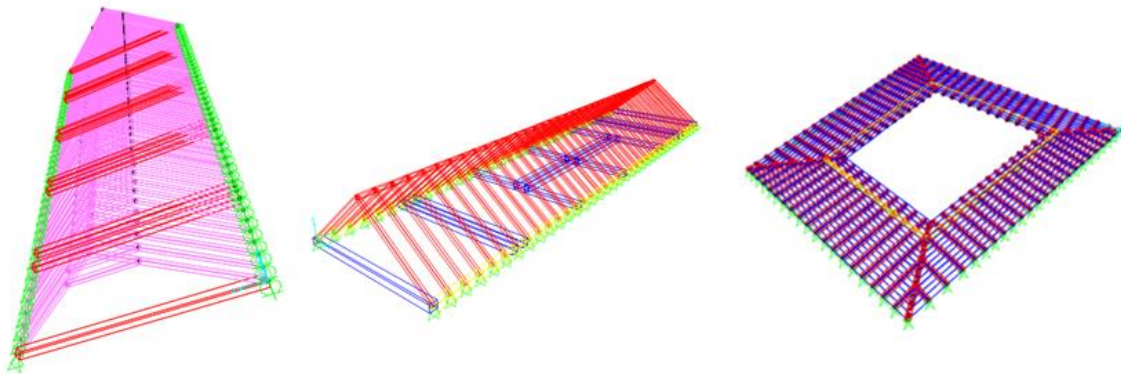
Construcción de los modelos de las diferentes cubiertas de tipología colonial – SAP 2000. Fuente: Autores (De izquierda a derecha, cubierta Par y Nudillo, cubierta Par e Hilera y cubierta Plana en Terraza).
